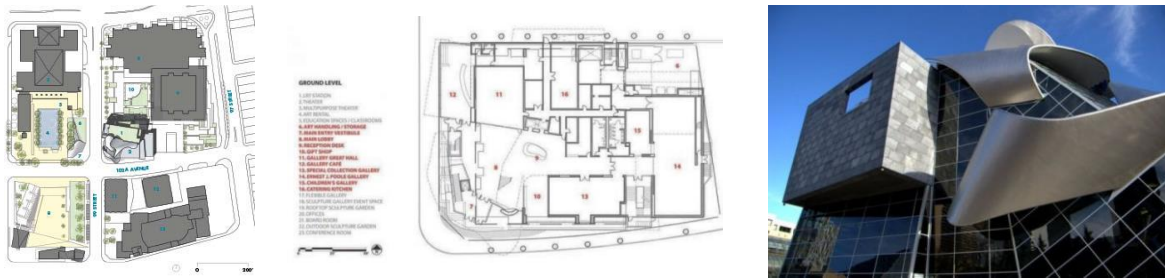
Galería de Arte, Alberta, Canadá, Arq. Randall Stout. (2010).
